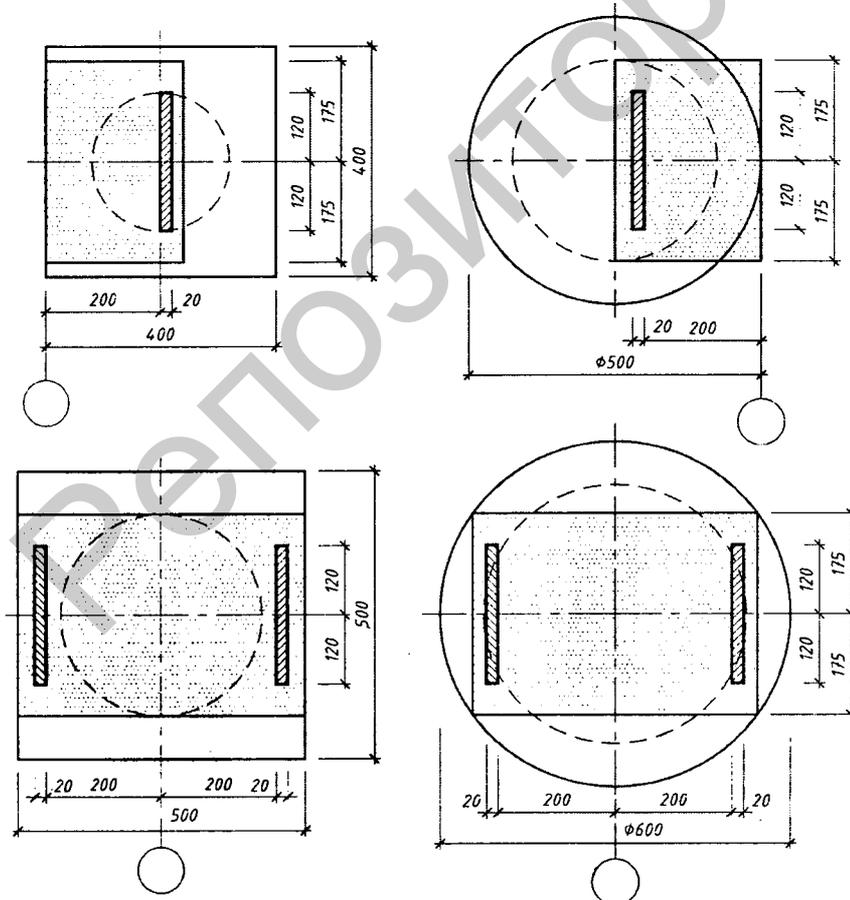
Расположение опорных ребер стальных стропильных конструкций на оголовках колонн
